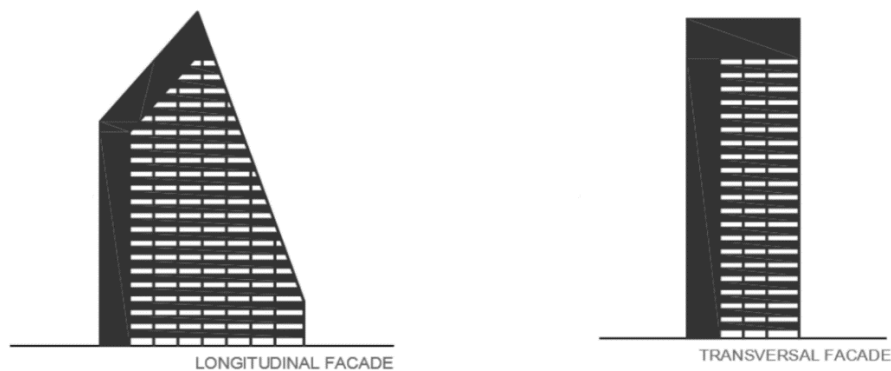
Fachadas propostas pelo *UT system* (Silva *et al.*, 2013).
